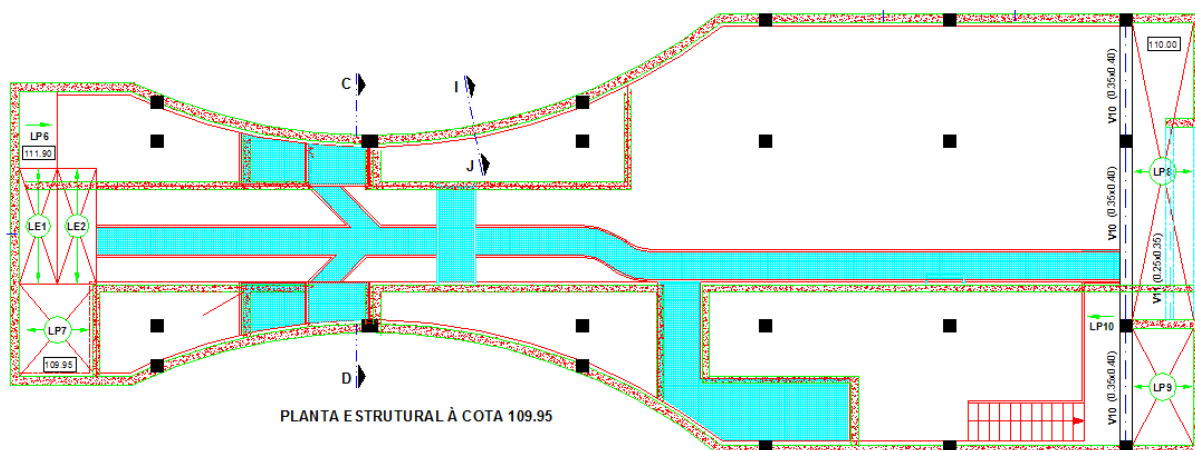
Planta Estrutural da Câmara de Manobras à cota 109.95
